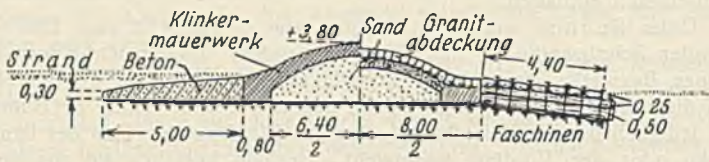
Undurchlässige Buhnen aus Mauerwerk vor Blankenberghe. etwa 1:265.
